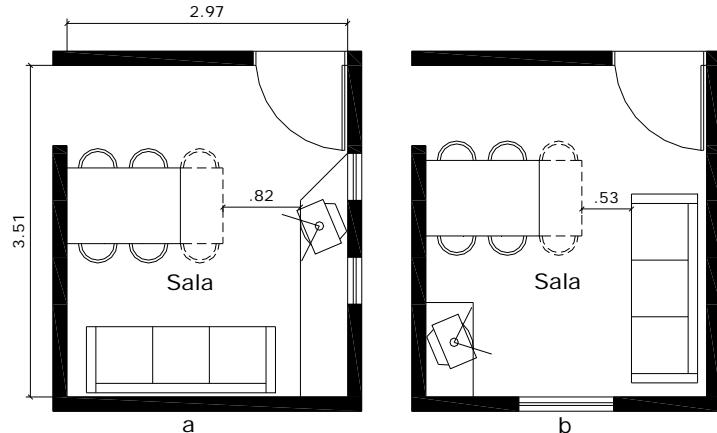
Planta baixa (com mobília proposta pelos construtores) de unidade original do Conjunto Osman Loureiro.
